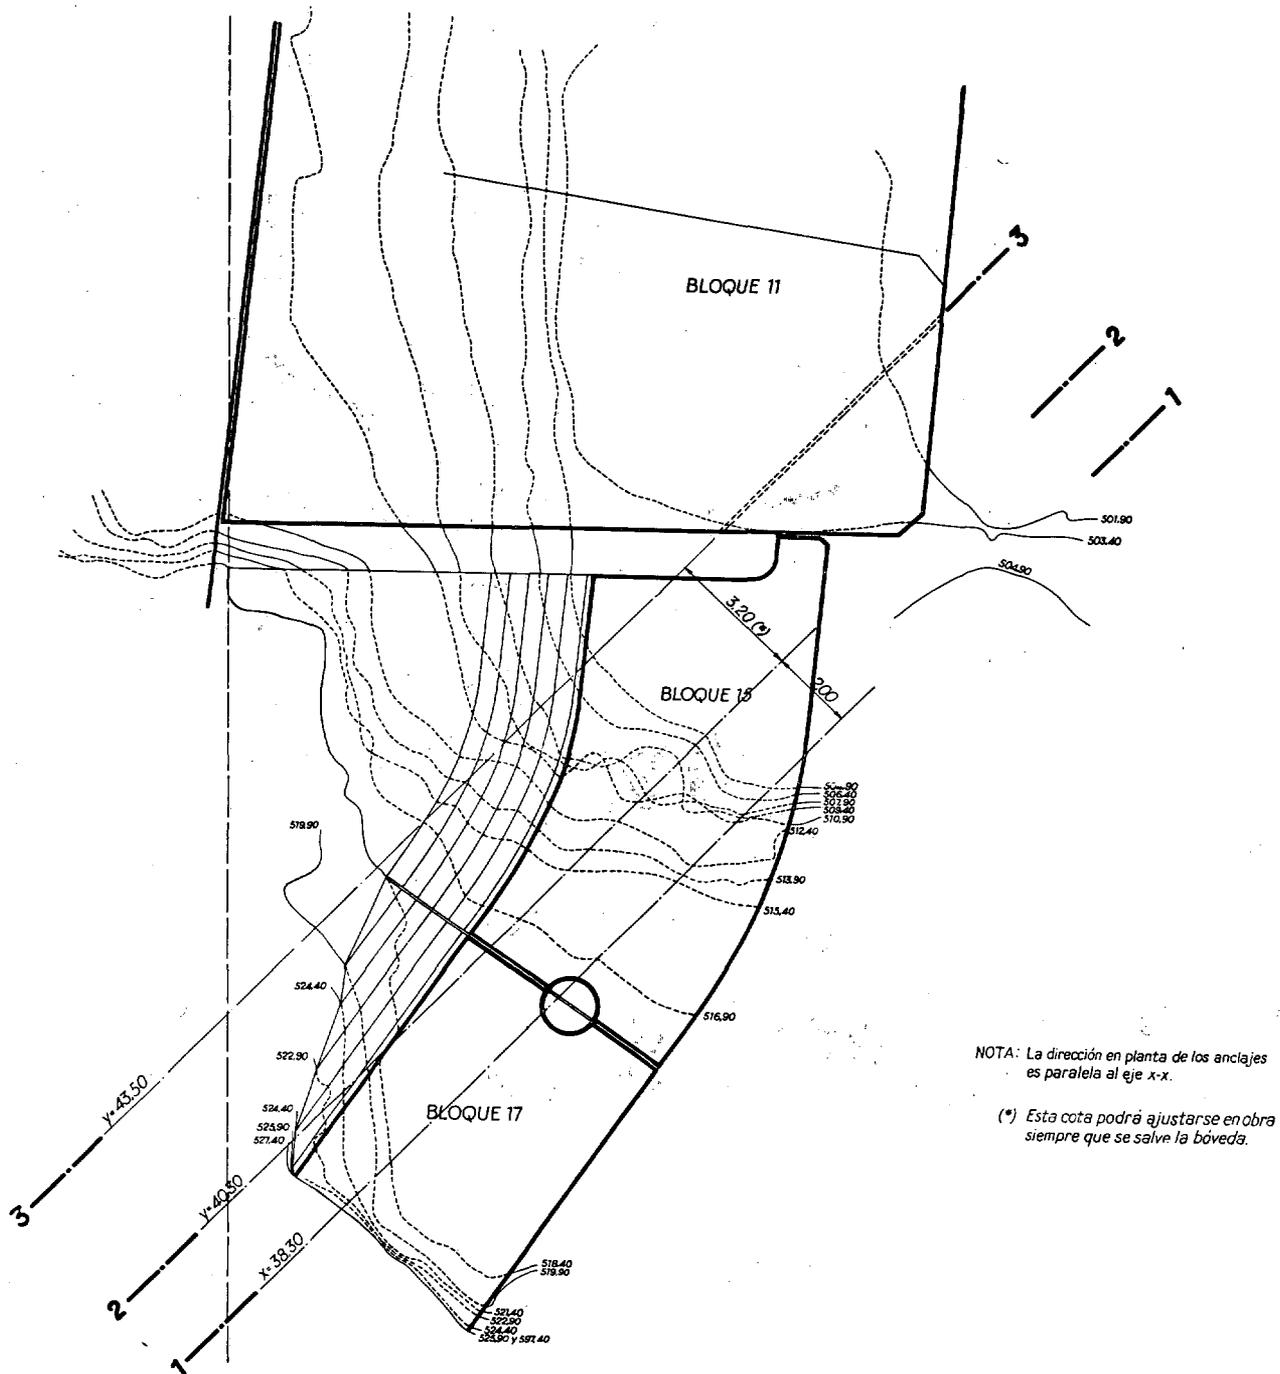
Presa de Santa Eulalia, Planta del muro en ala del estribo derecho.
